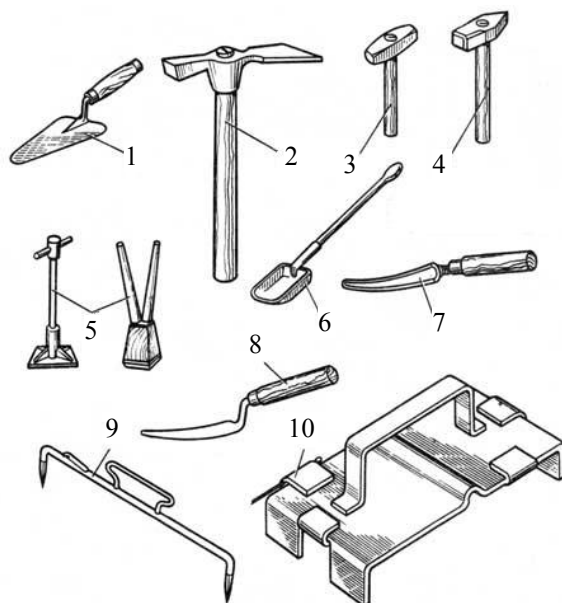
Інструменти для виробництва кам'яного мурування: 1 – кельма; 2 – молоток-тесельце; 3 – кувалда прямокутна; 4 – те саме, гостроноса; 5 – трамбівка; 6 – лопата розчинна; 7 – розшивка для оброблення опуклого шва; 8 – те саме, для оброблення увігнутого шва; 9 – причальна скоба з защіпкою; 10 – те саме, з оцинкованого листа зі шнуром
